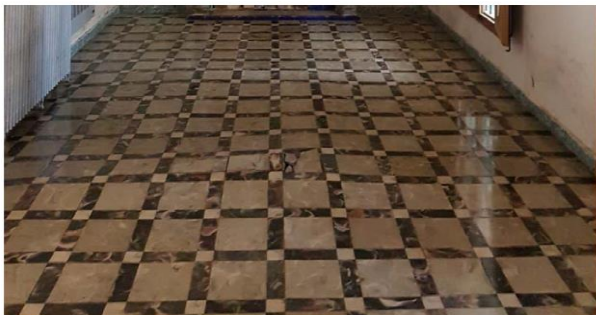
Pavimentos existentes de origen. 2023. Fuente: propia.
